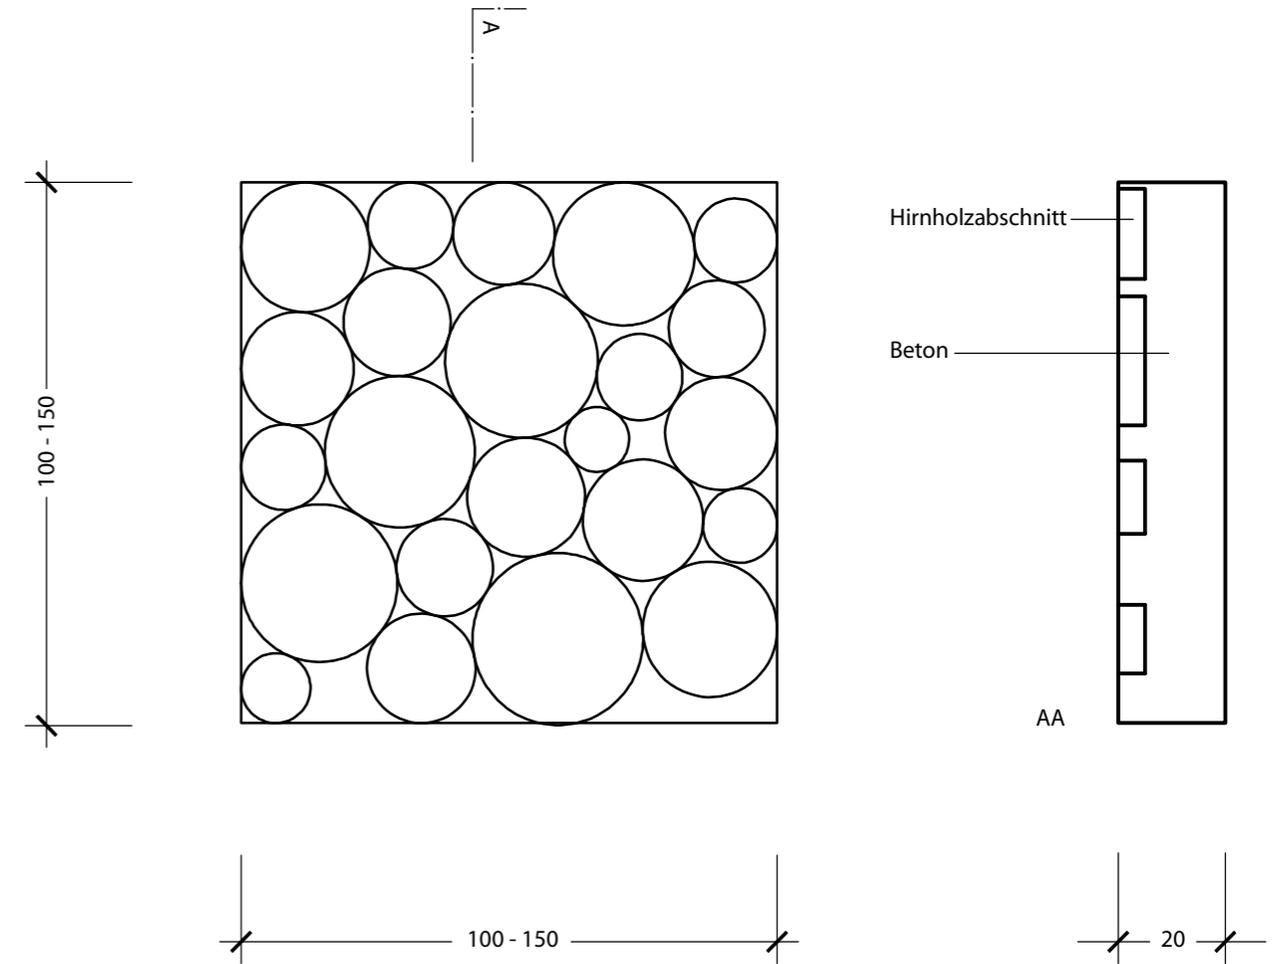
Studie Fassadenelement Holz-Beton Verbund mit Hirnholzabschnitten
